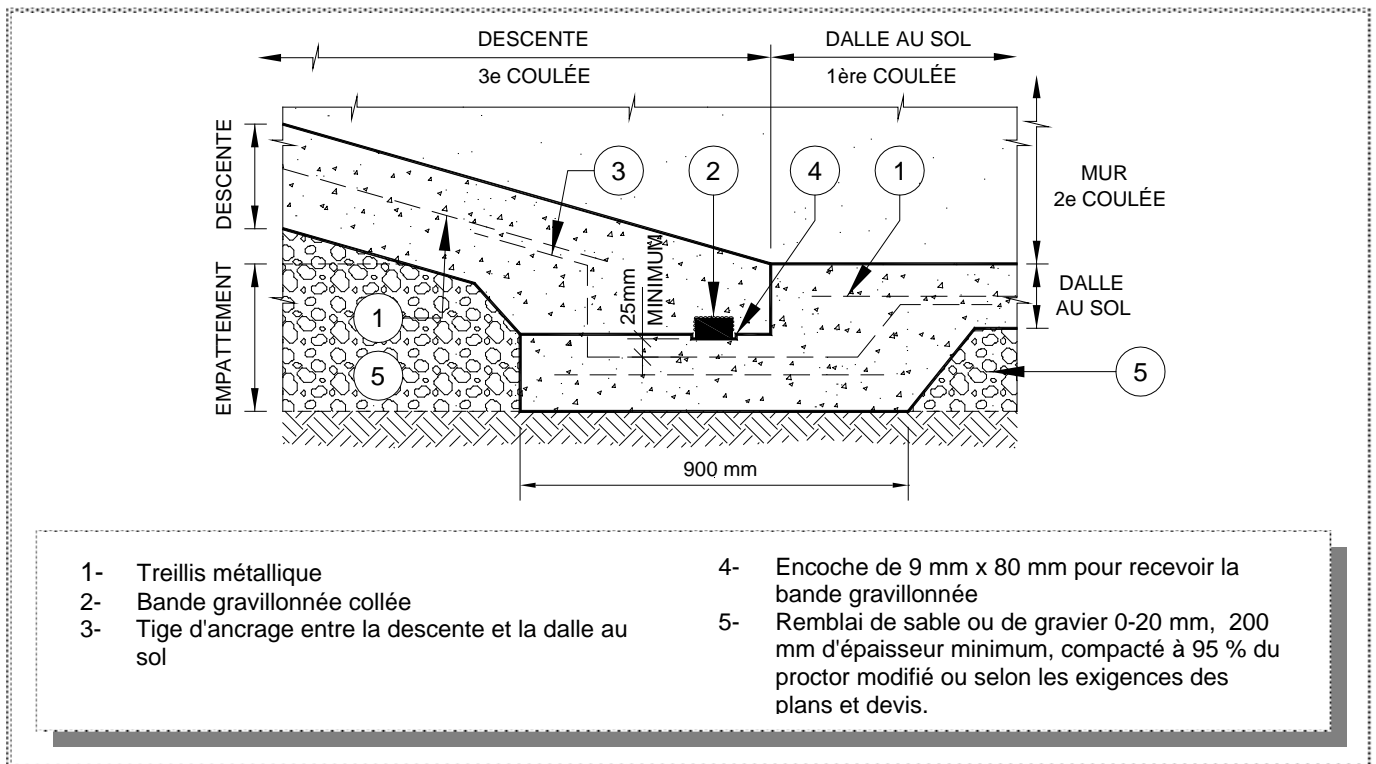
Étanchéité entre la dalle et la descente (Joint de construction)
